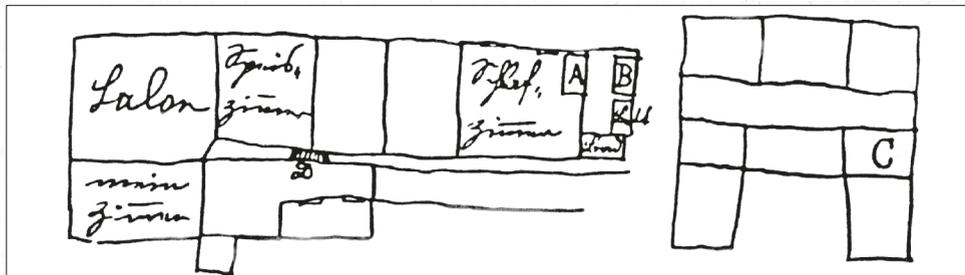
eigenhändige Skizze Boltzmanns/sketch by Boltzmann
